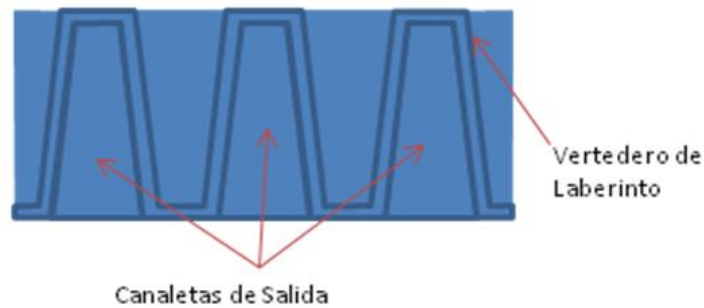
Vista en planta del vertedero de laberinto y las canaletas de salida.
